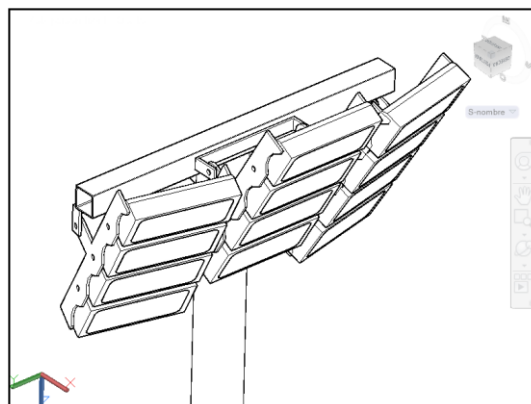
Montaje en parte superior de mástil. Cancha de Fútbol Sintético. Autocad 3D
